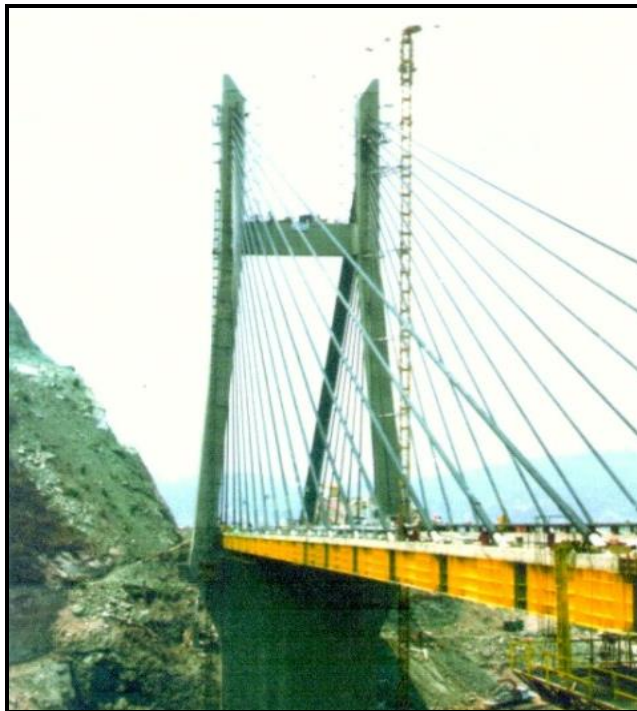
Puente Barranca del Zapote, 1993
